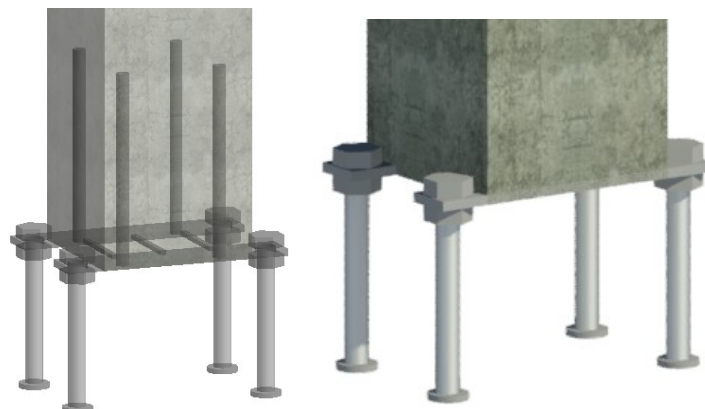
Узловое соединение сборных железобетонных колонн с фундаментами с применением закладной детали (иллюстрация авторов)
